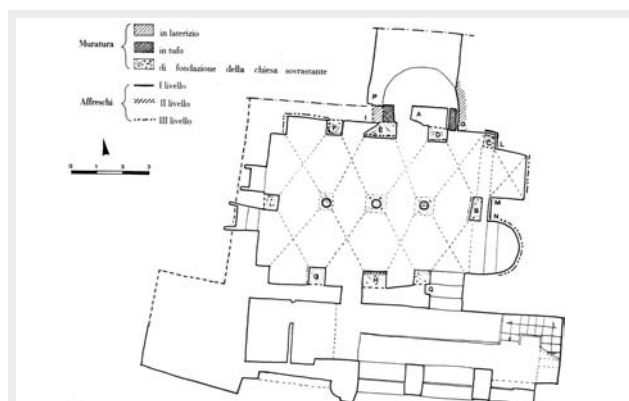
Salerno. Chiesa di Santa Maria 'de Lama'. Pianta della cripta.
